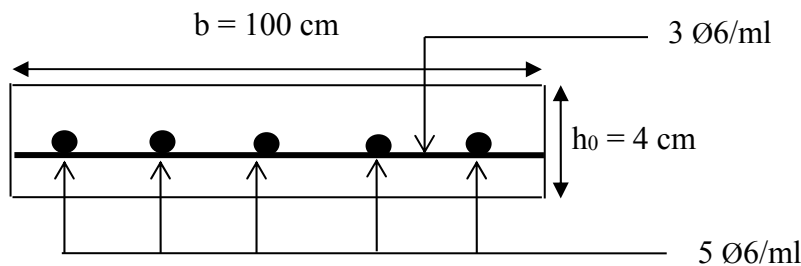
Schéma de ferrailage de la dalle de compression
